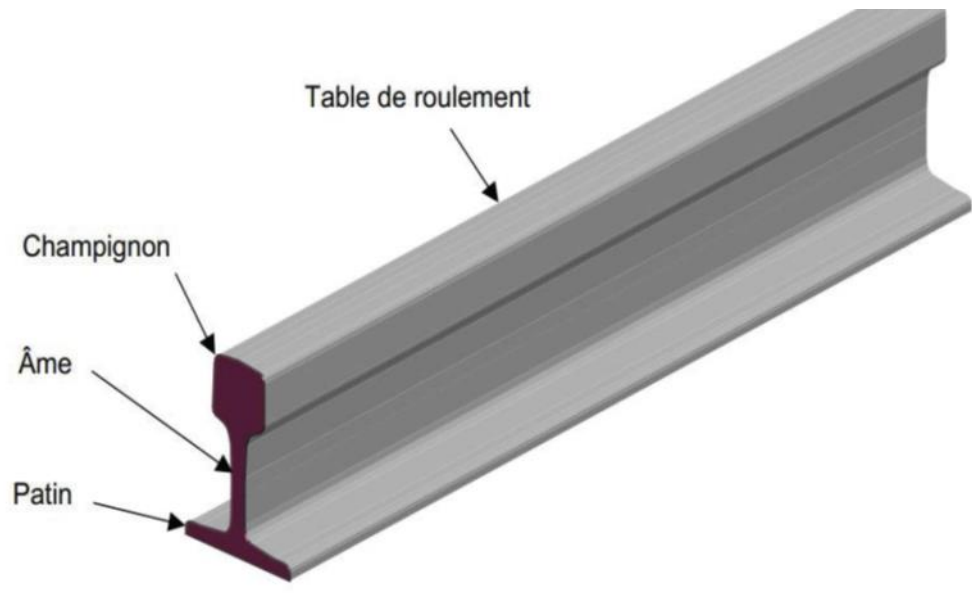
Le rail Vignole (UIC 60). [5]
